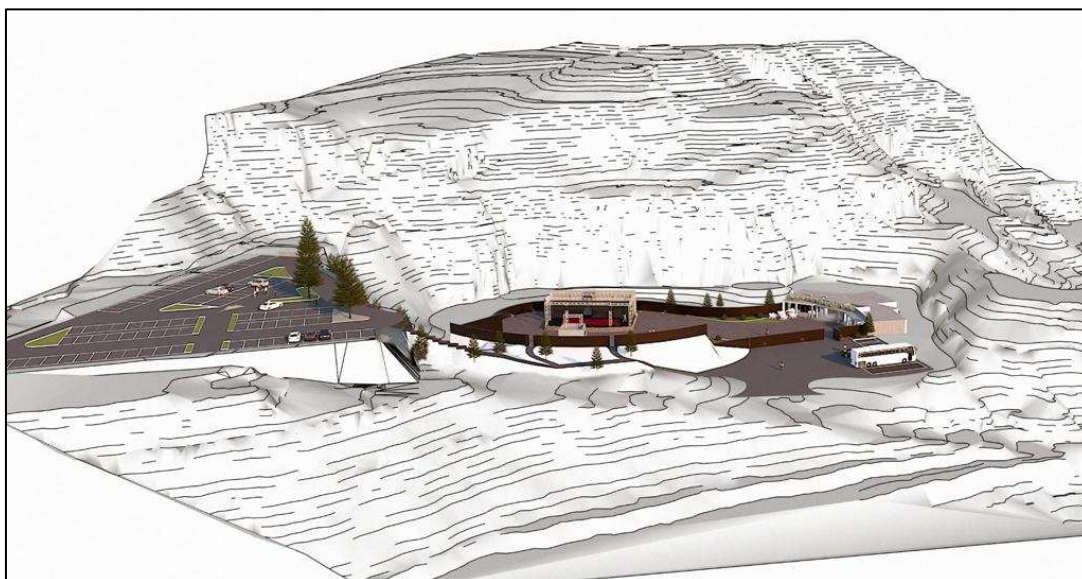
Progetto di recupero previsto dall'arch. PierPaolo Botteon
